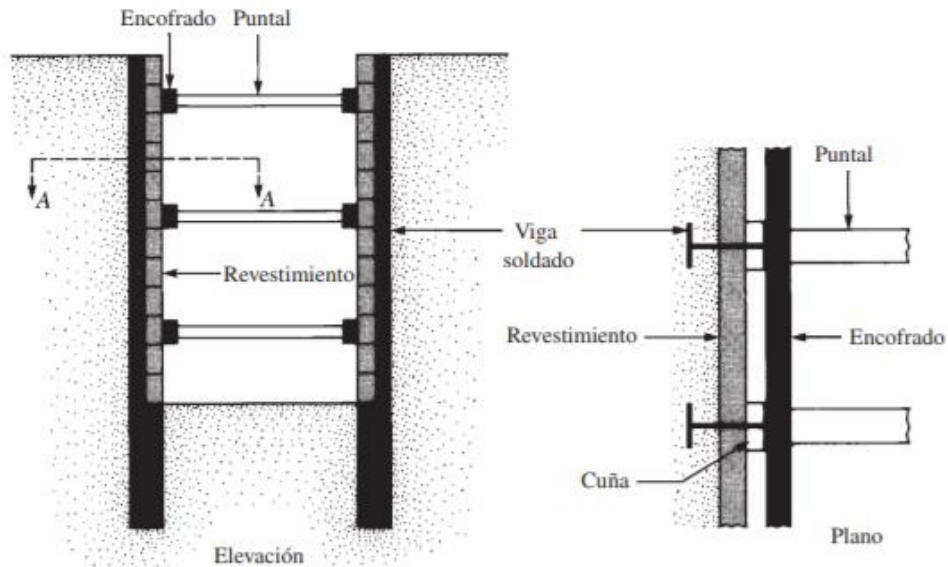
Uso de vigas soldado (Obtenido de Fundamento de ingeniería geotécnica Braja M. Das)
